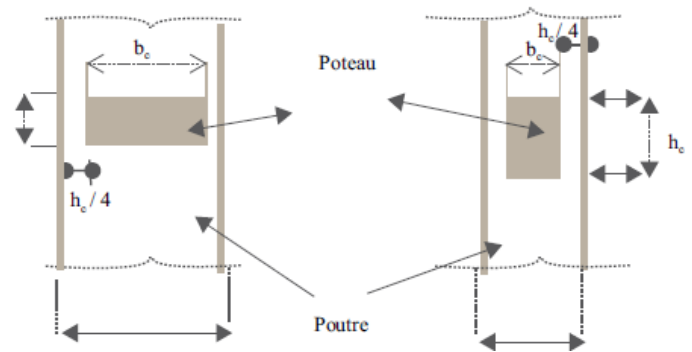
DIMENSIONS MINIMALES DU POTEAU (RPS2011)
